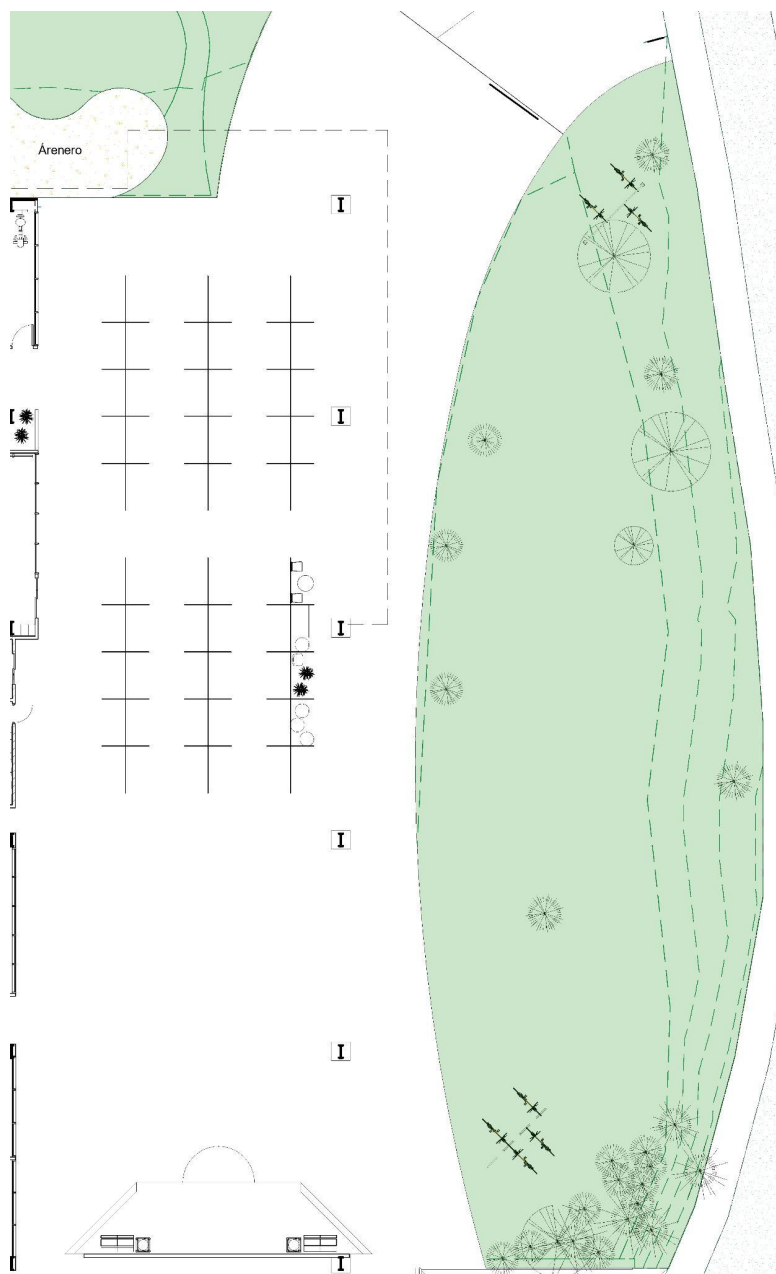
Detalle de la planta del área ferial. Fuente propia.
